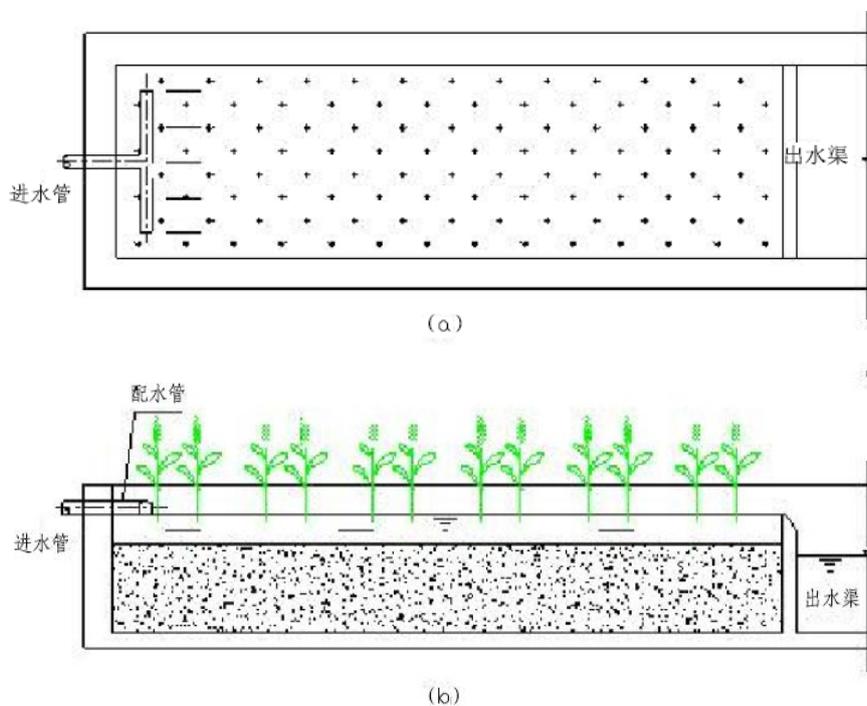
表面流人工湿地结构简图 (a) 平面图 (b) 剖面图
